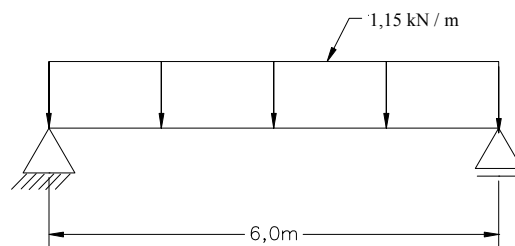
Aplicação da ação da carga permanente sobre a viga de rolamento.
